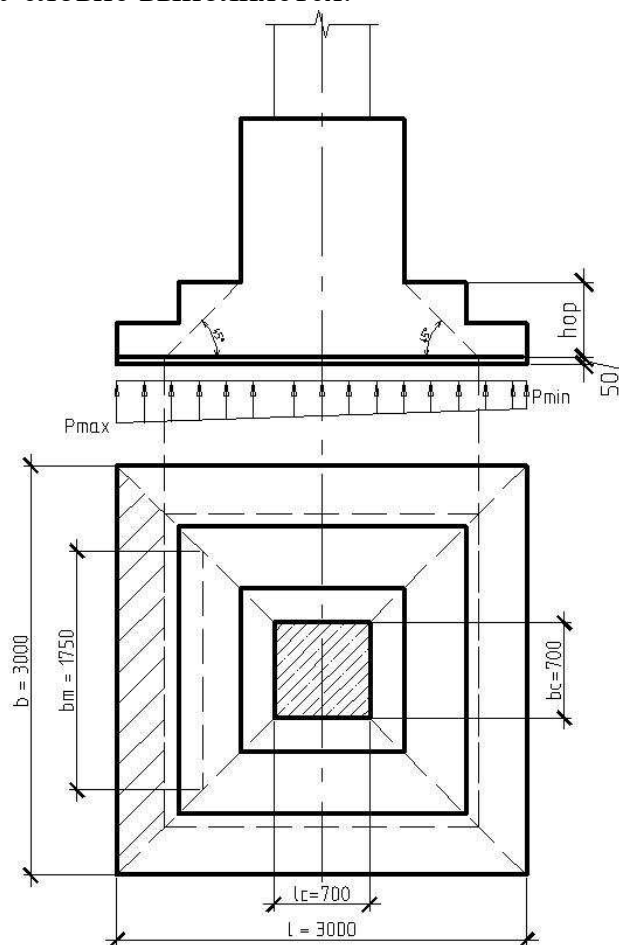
Схема к расчету низкого фундамента на продавливание подколонником
